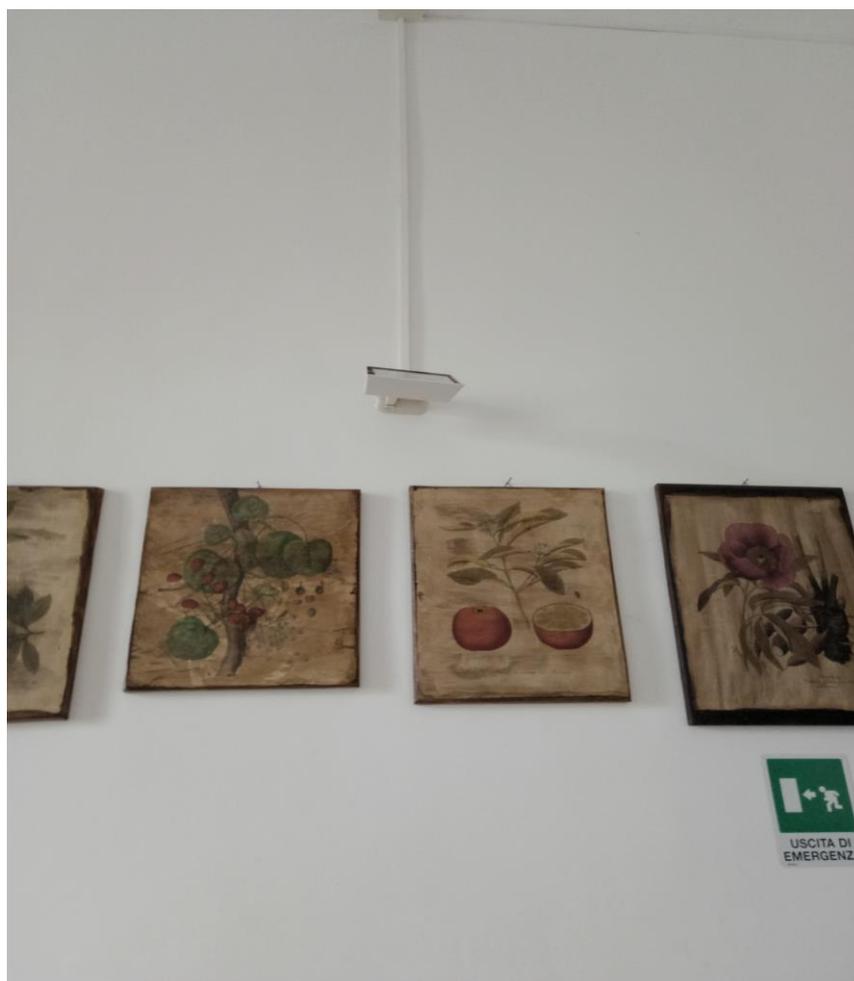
Corpo illuminante utilizzato nella sala d'aspetto
